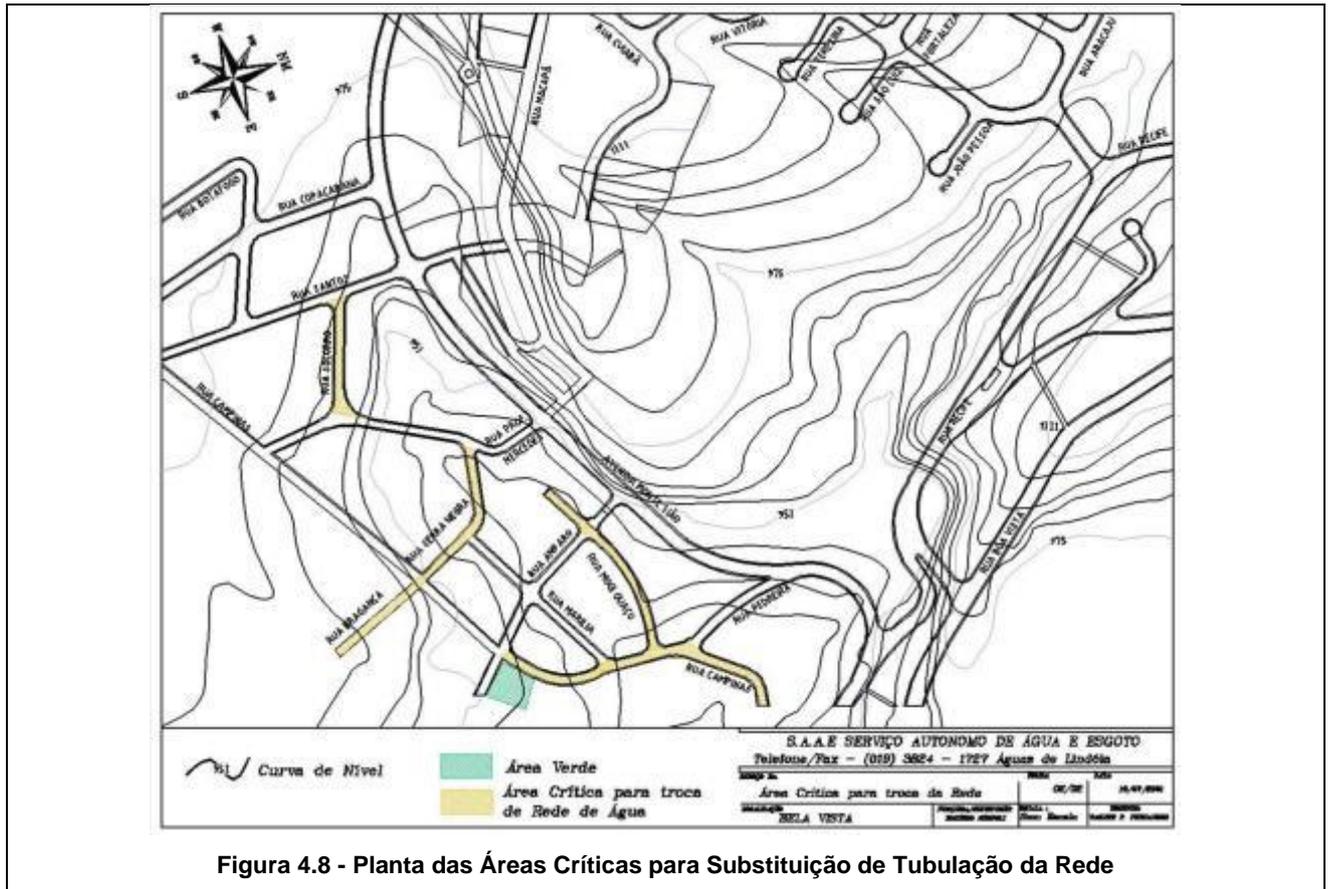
Planta das Áreas Críticas para Substituição de Tubulação da Rede
